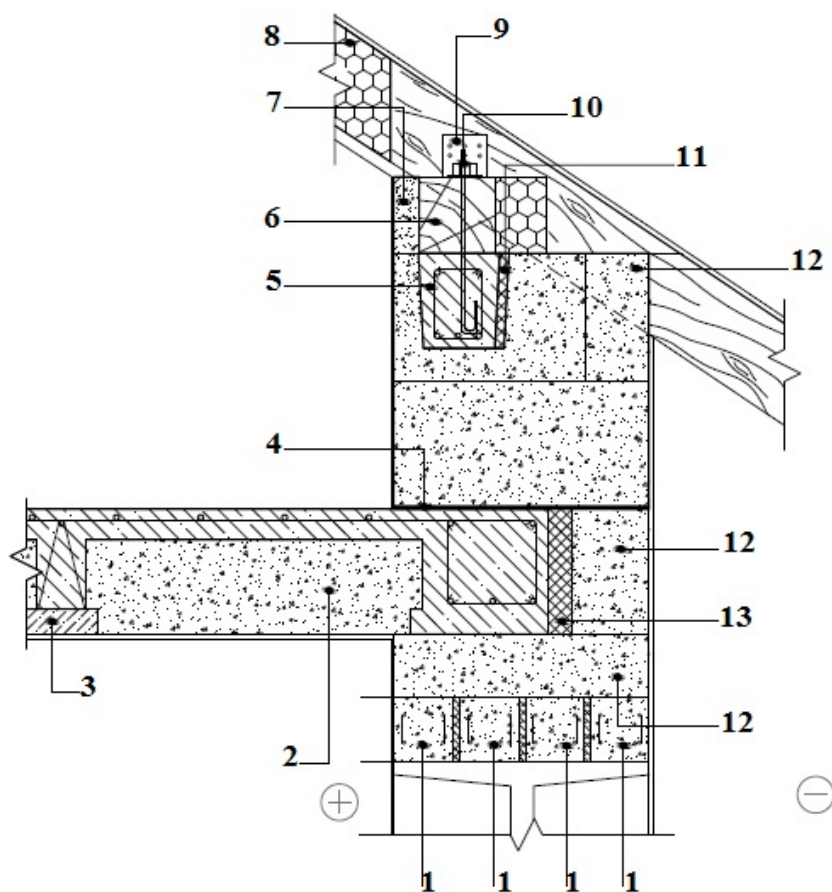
Сопряжение несущей стены из газобетона с мансардным этажом и сборно-монолитным перекрытием: 1 — перемычка YTONG; 2 — Т-образные блоки; 3 — балка перекрытия; 4 — растворный шов, 10–30 мм; 5 — монолитный пояс в U-образных блоках; 6 — брус мауэрлата; 7 — блоки YTONG; 8 — минеральная вата; 9 — анкерный уголок; 10 — шпилька резьбовая, шайба, гайка (Ø 12 мм); 11 — минераловатная или экструзионный пенополистирол (ЭППС) толщиной 30 мм; 12 — доборный блок; 13 — ЭППС толщиной 50 мм
